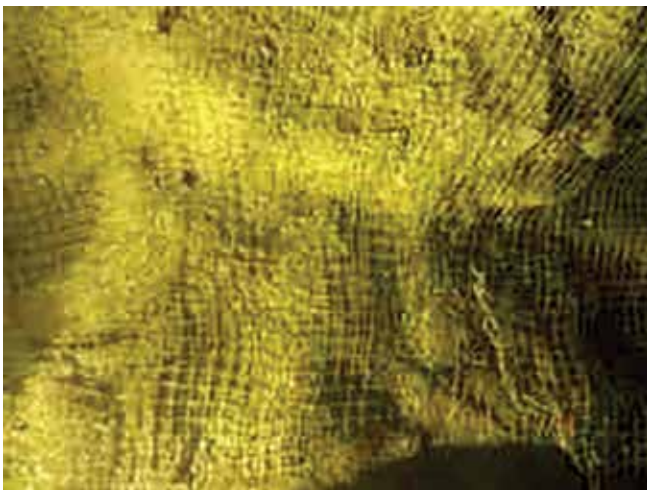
Concreto lanzado muy delgado con toda la malla expuesta
